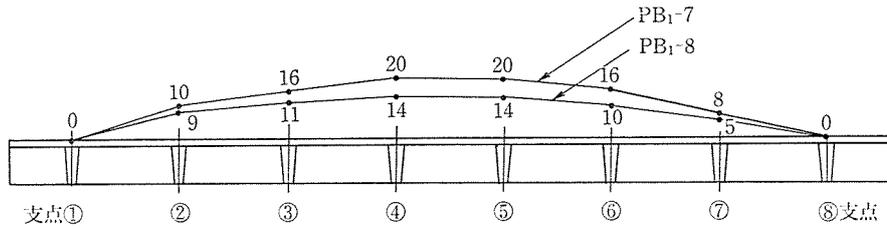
PCa 部材の一次緊張後のむくり量 (mm)
